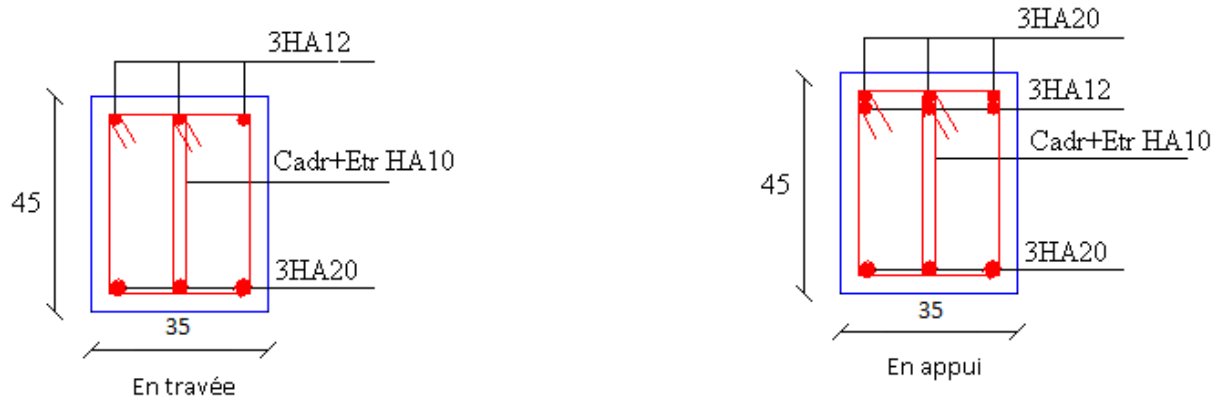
Schéma du ferrailage des poutres principales 5^{ème}entr Sol et parking
